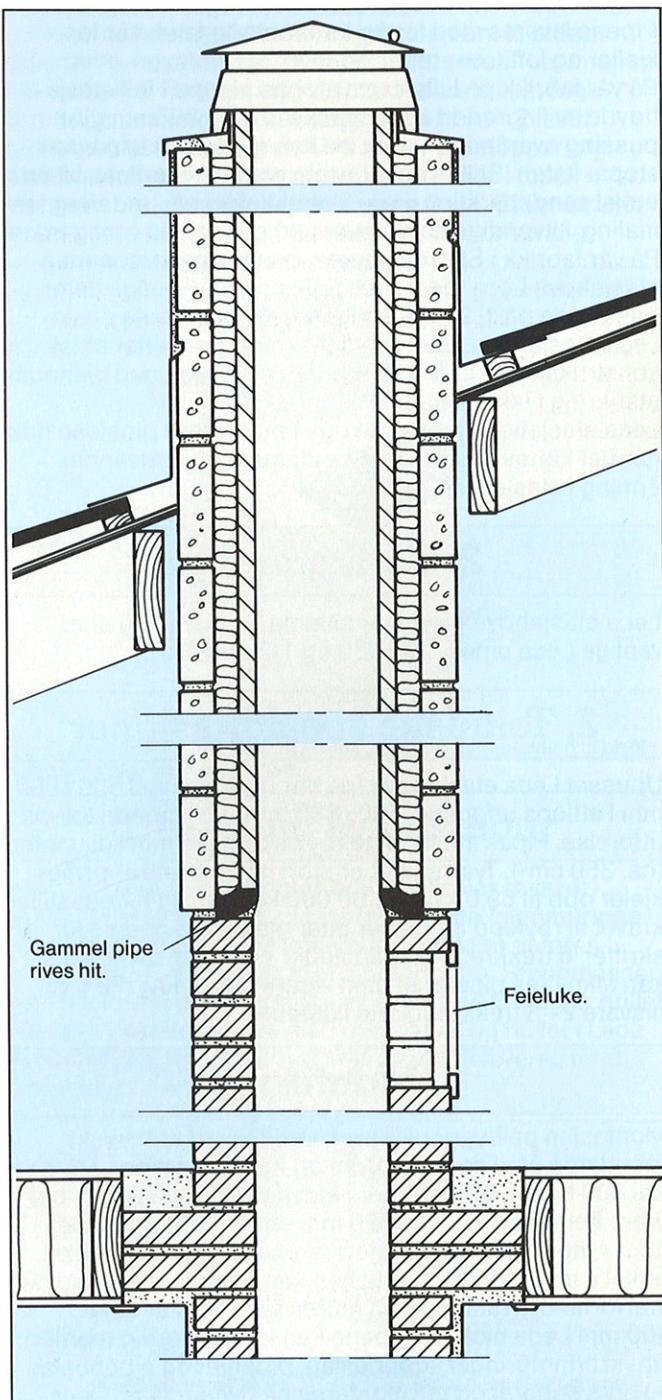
Leca pipe som isolert konstruksjon fra feieluke på loft.
